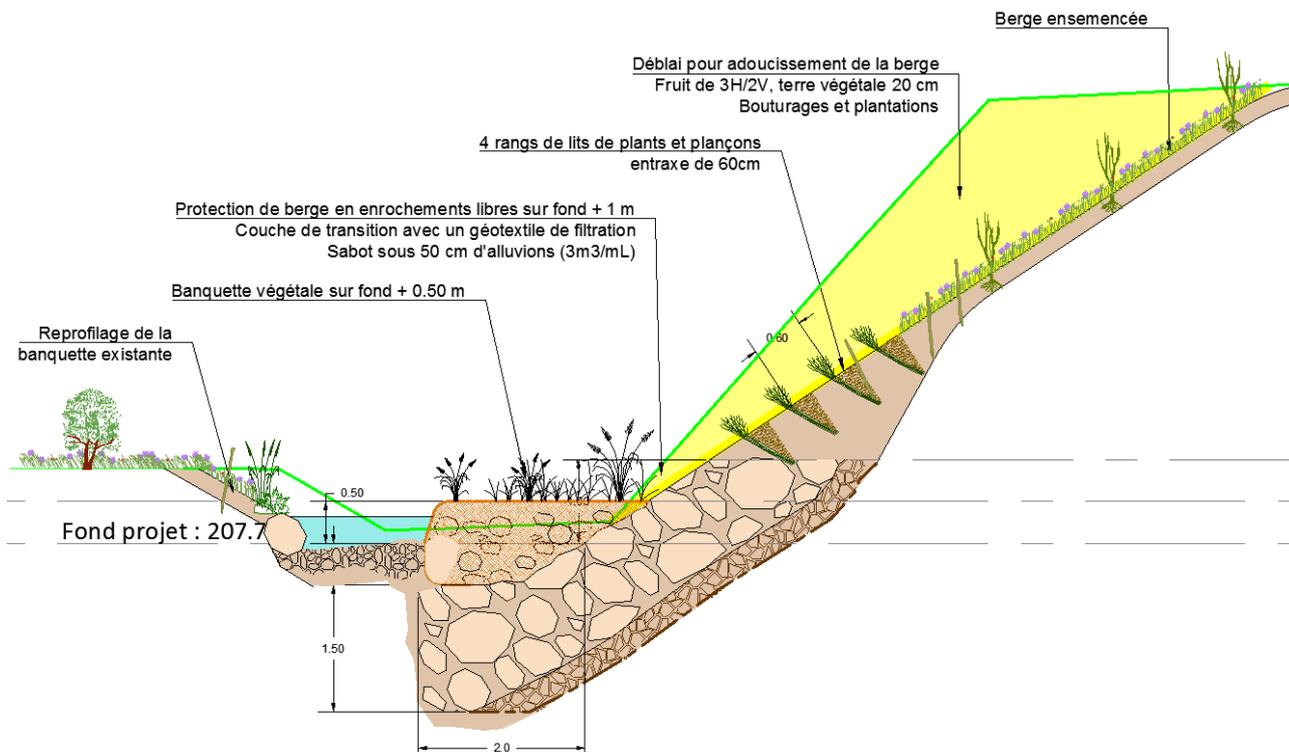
Profil en travers au droit du projet communal – section avec banquette végétalisée
